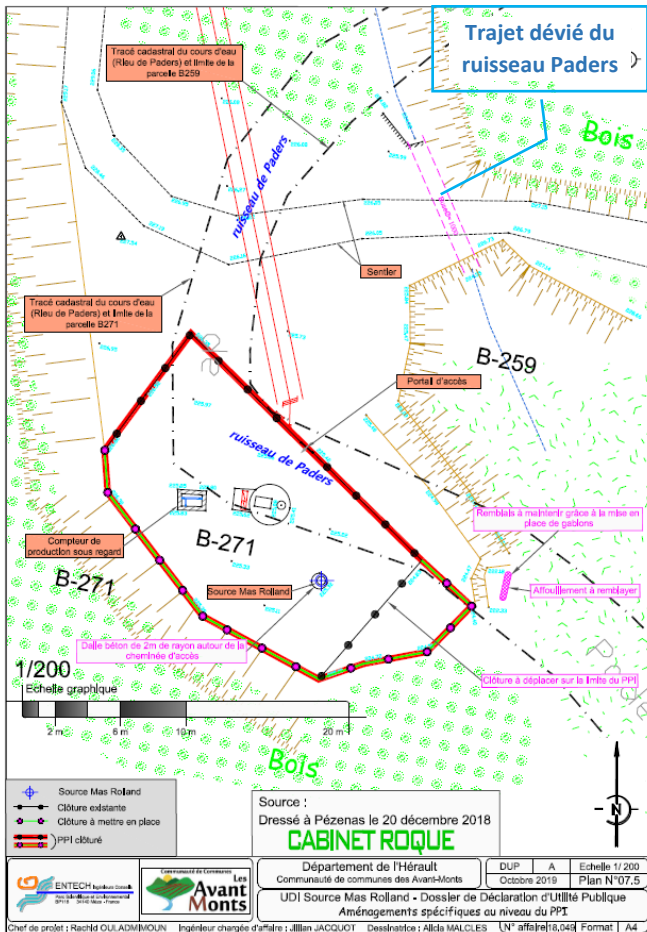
Plan de masse du site du captage de Mas Rolland sur fond cadastral (Plan N°7.5 de la Pièce N°6 : Livret des documents graphique du dossier d'enquête publique)
